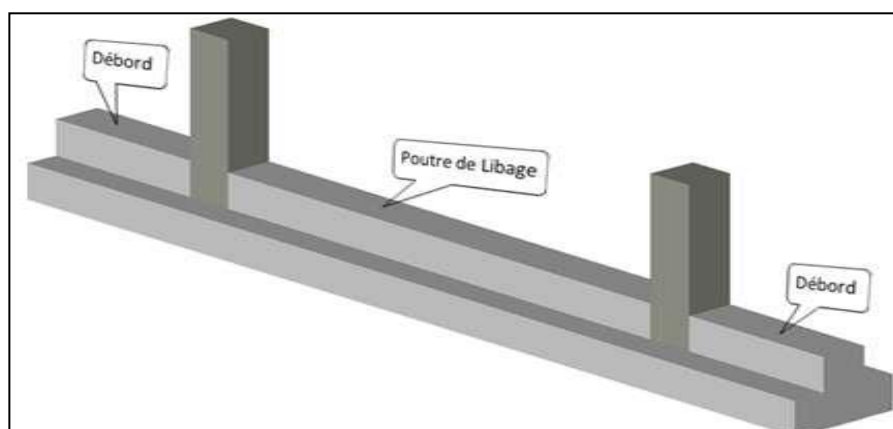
Schéma d'une semelle filante sous poteaux
